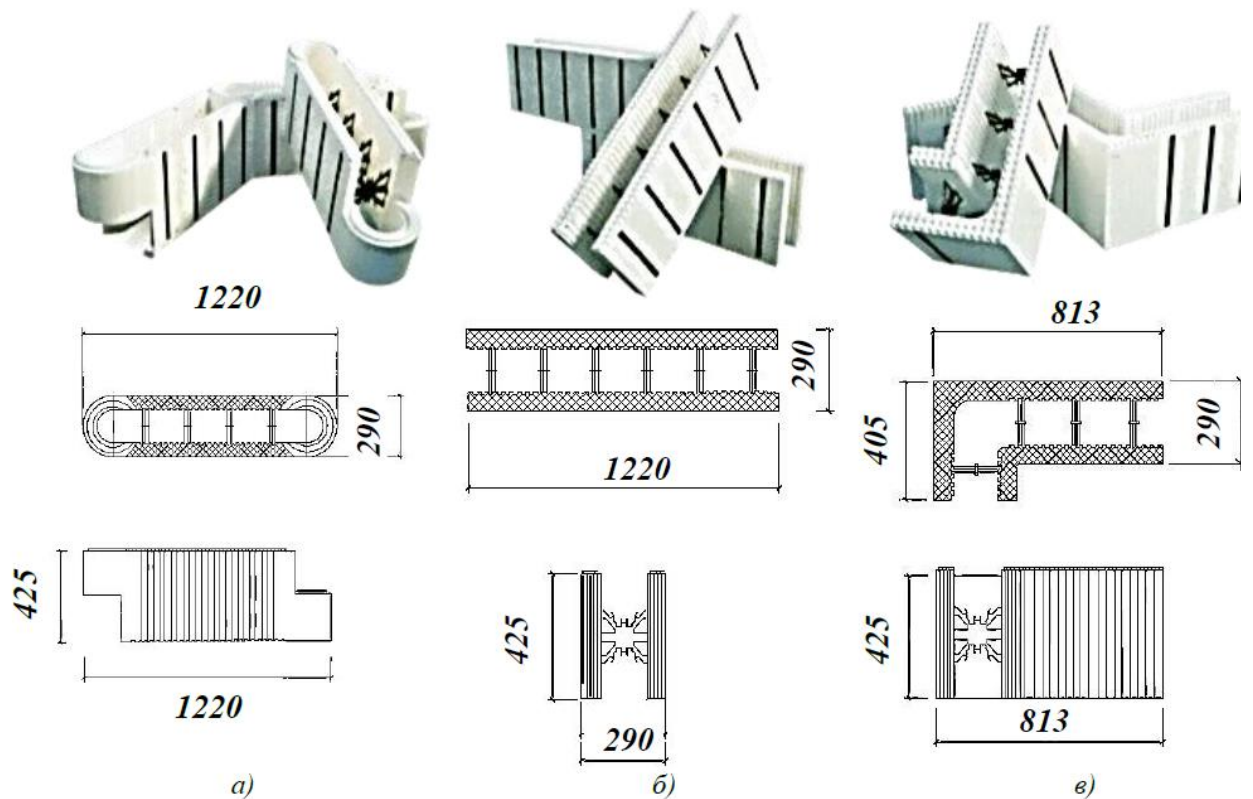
Типи блоків: а - поворотний; б - кварта; в - кутовий
